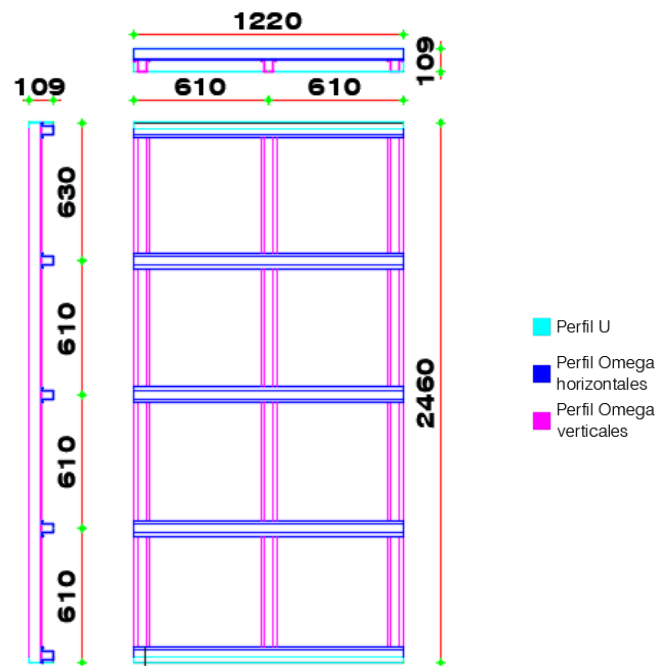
Dimensiones del Panel Llano de 1.220mm x 2.460mm
